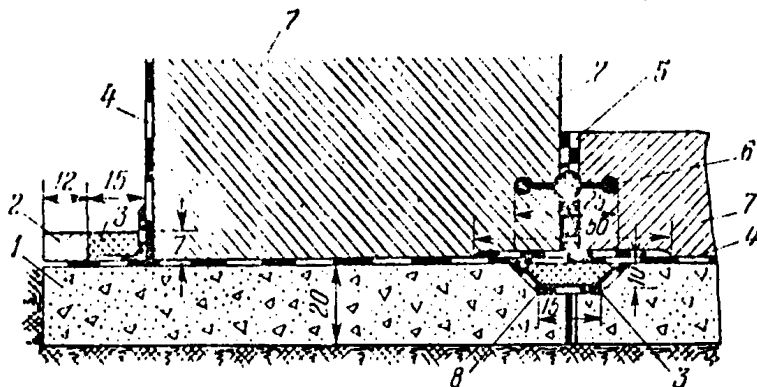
Сопряжение гидроизоляции основания с гидроизоляцией стен
